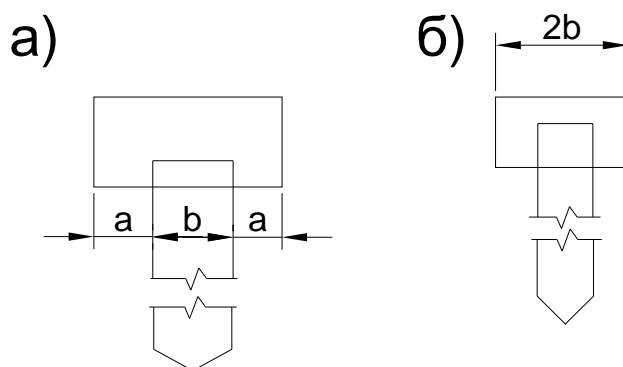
К расчету ширины монолитного ростверка свайного фундамента
